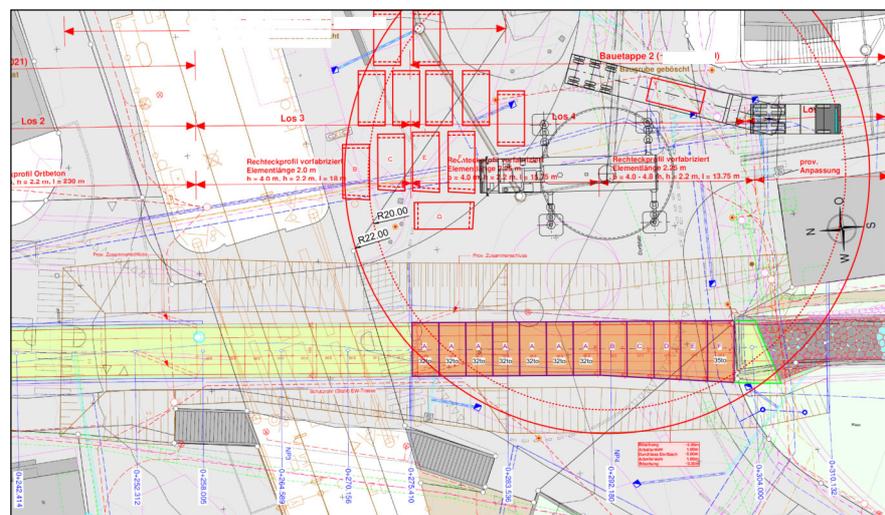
Installationsplan, Montage Elemente Dorfplatz (Quelle: Fanger Kies + Beton AG, Sachseln)
